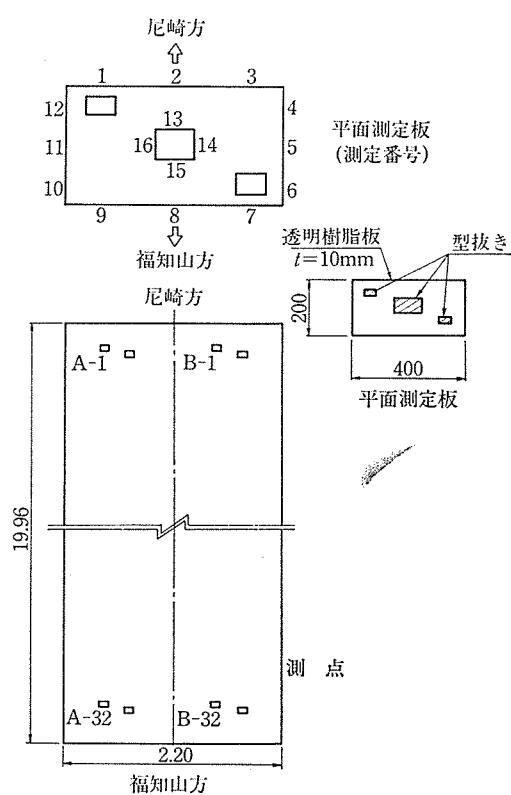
軌道部コンクリート上面の仕上げ精度測定位置 (亀治B)
